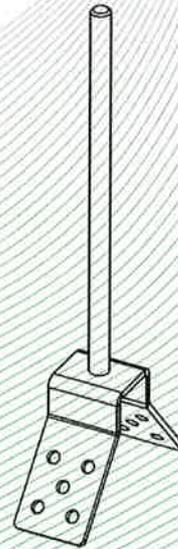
Anschlagereinrichtung, Typ: ZS 300 FIRST, mit gekanteter Grundplatte
